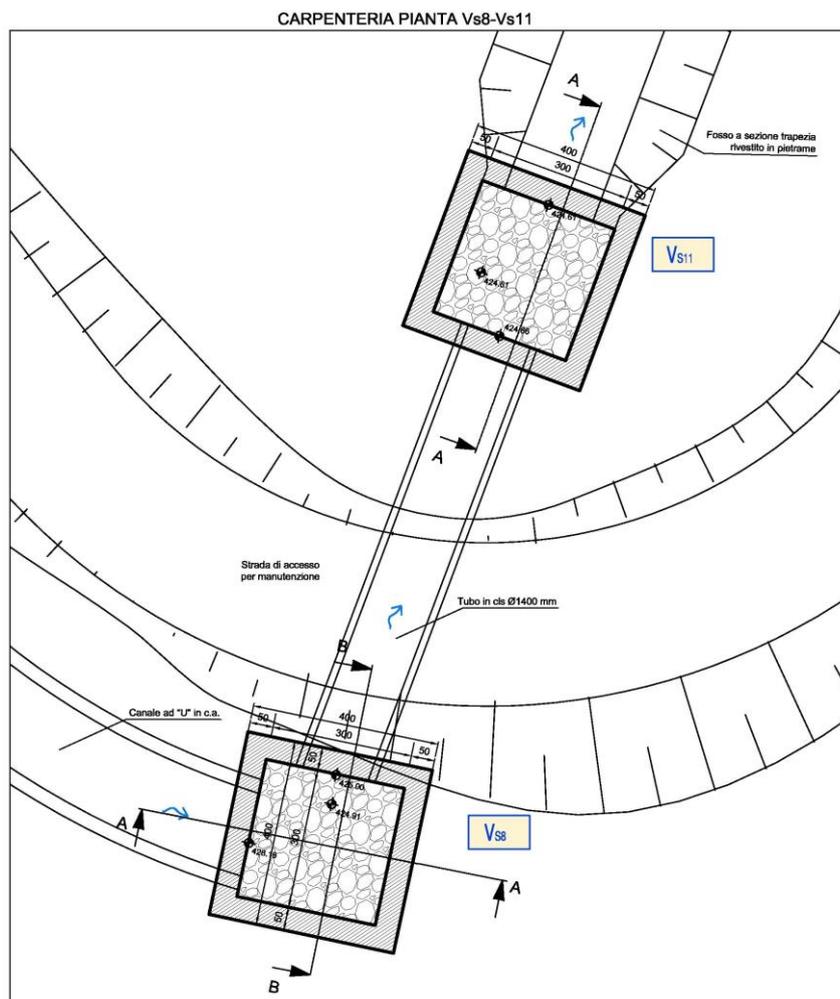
Sistema compluvio sud – Pozzetti VS8-VS11 - Pianta
